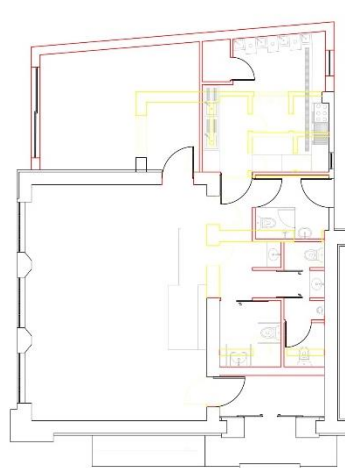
Planta com a estrutura e equipamentos fixos definidos.
